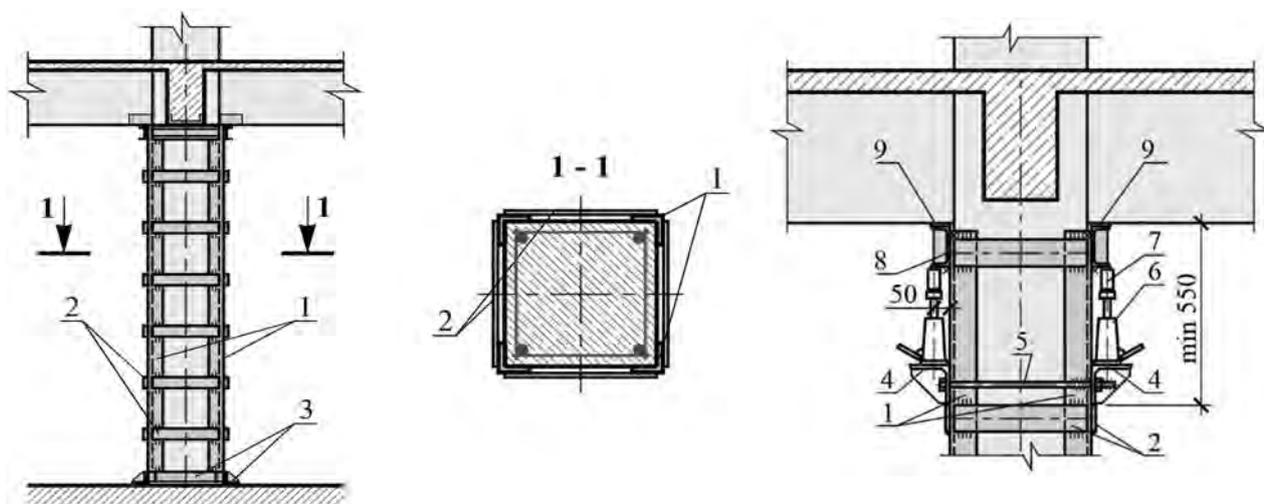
Схема стальной обоймы без применения бетона: 1 – прокатные уголки; 2 – поперечные пластины; 3 – опорные элементы; 4 – временный опорный столик; 5 – стяжной болт временного столика; 6 – домкрат для создания предварительного напряжения; 7 – динамометр; 8 – упорный элемент (швеллер); 9 – неопреновая прокладка
